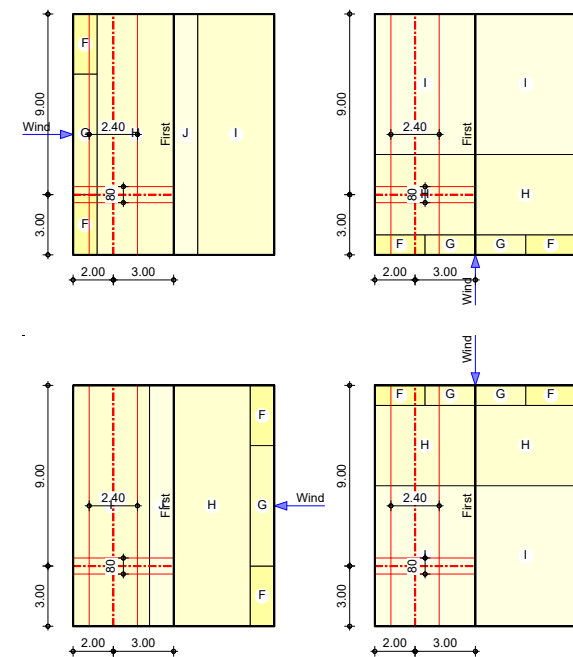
Beispielausgabe Lage eines Bauteils im Dach
